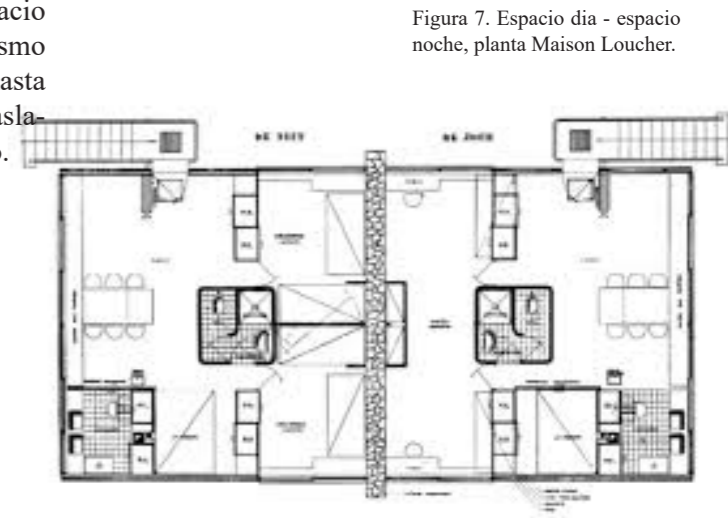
Espacio día - espacio noche, planta Maison Loucheur.
